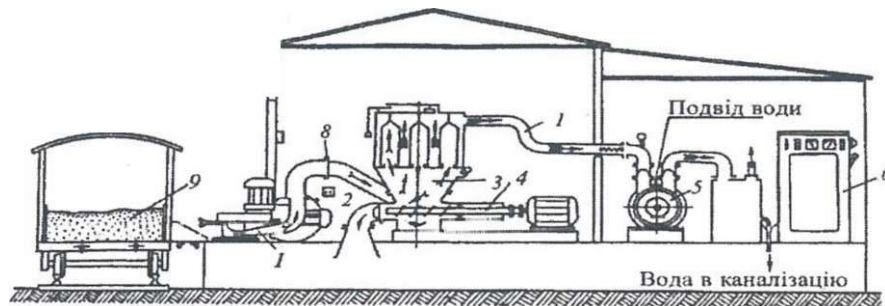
Схеми роботи пневматичного розвантажувальника 1 - забірний пристрій; 2 - переносний пульт управління; 3 - осаджувальна камера; 4 - напорний розвантажувальний гвинт; 5 - вакуум-установка; 6 - шафа з електрообладнанням; 7 - гумово-тканинний рукав - повітропровід; 8 - цементовод; 9 - залізничний вагон з цементом.
